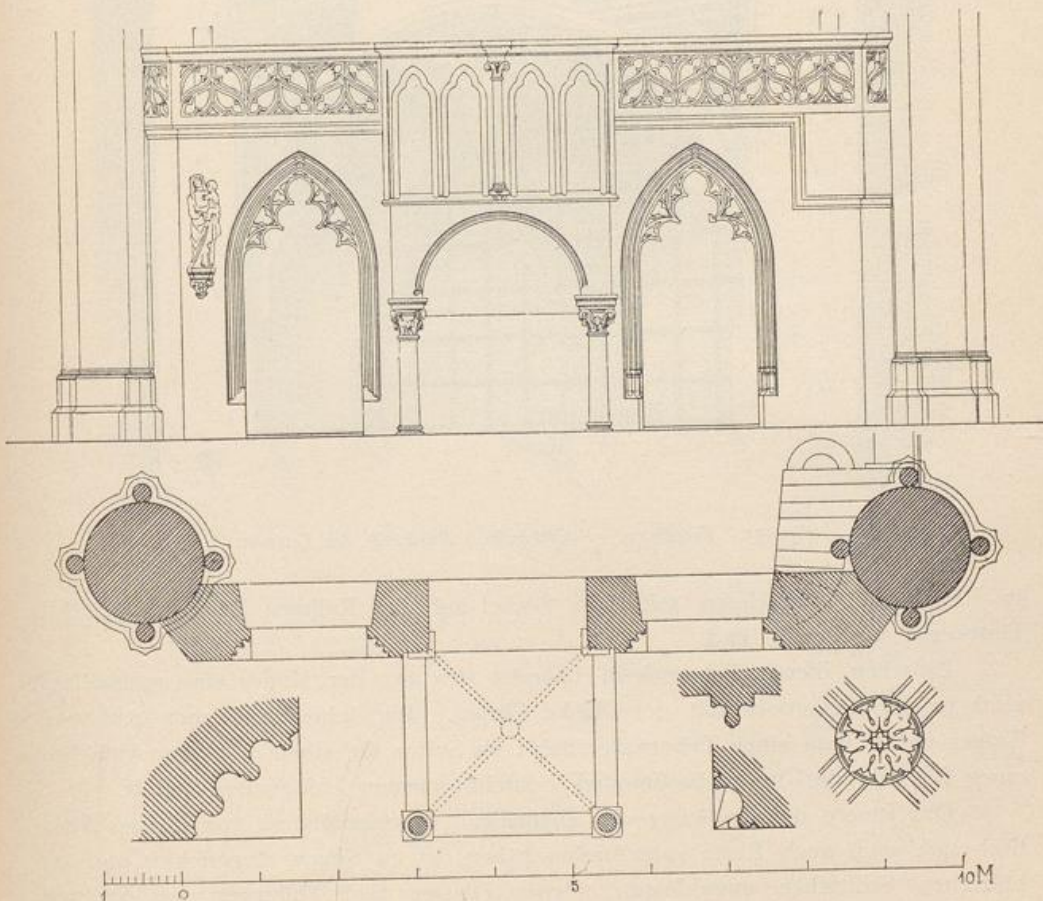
Friedberg. Stadtkirche. Lettner, Grundriss, Ansicht und Einzelheiten.
